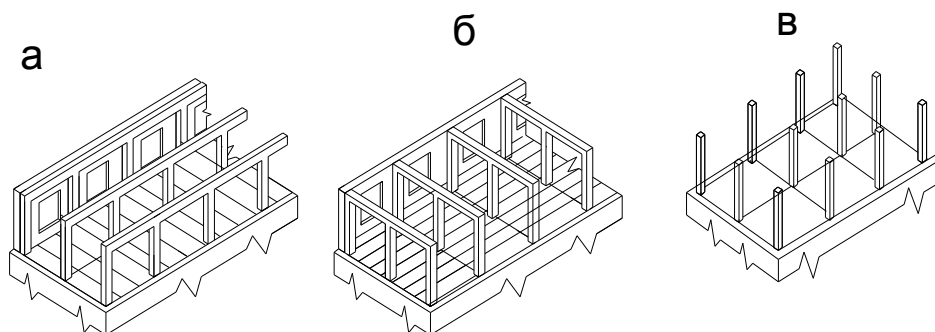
Конструктивные схемы каркасных зданий:
